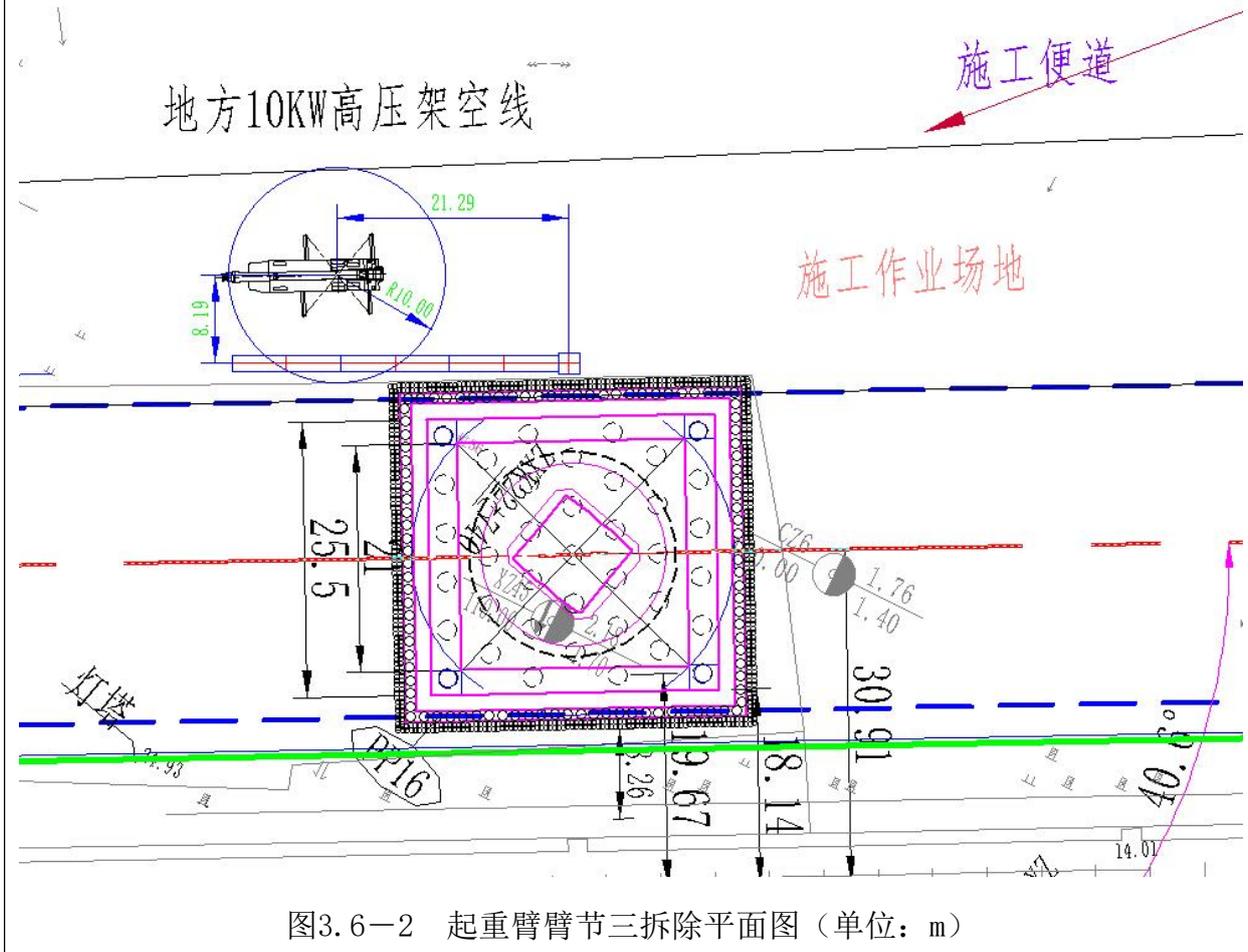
起重臂臂节三拆除平面图（单位：m）
